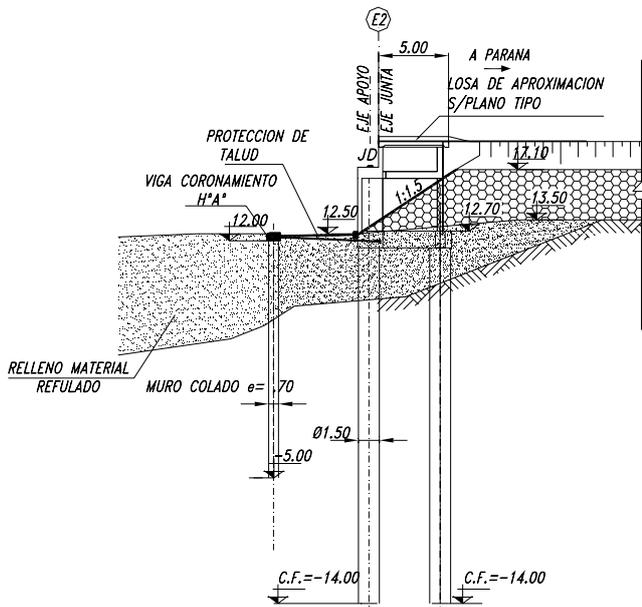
b Corte longitudinal de la solución de protección en nuevo estribo. Alternativa 1
